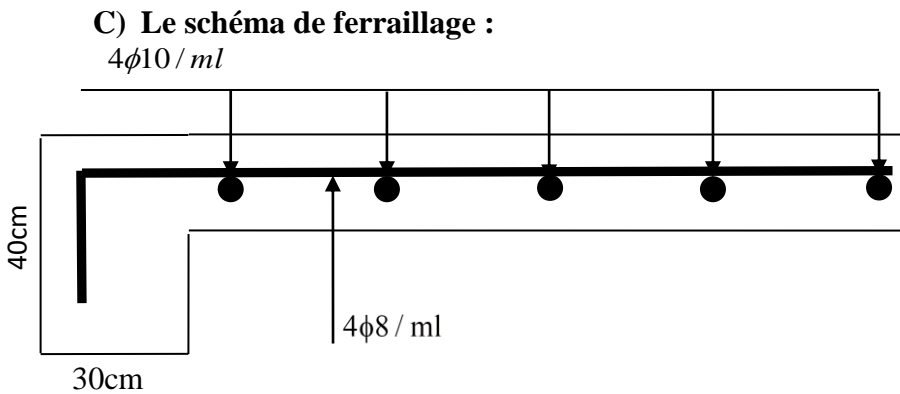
Schéma de ferrailage de la dalle pleine type1.
